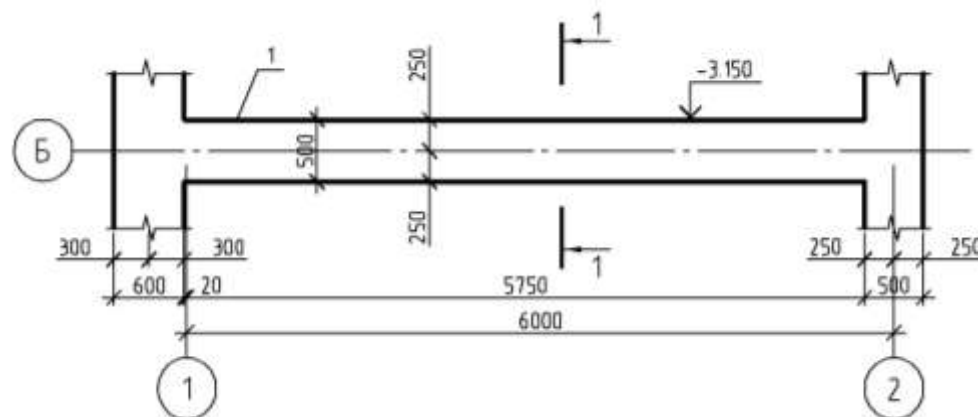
Пример оформления плана ростверка ленточного свайного фундамента
